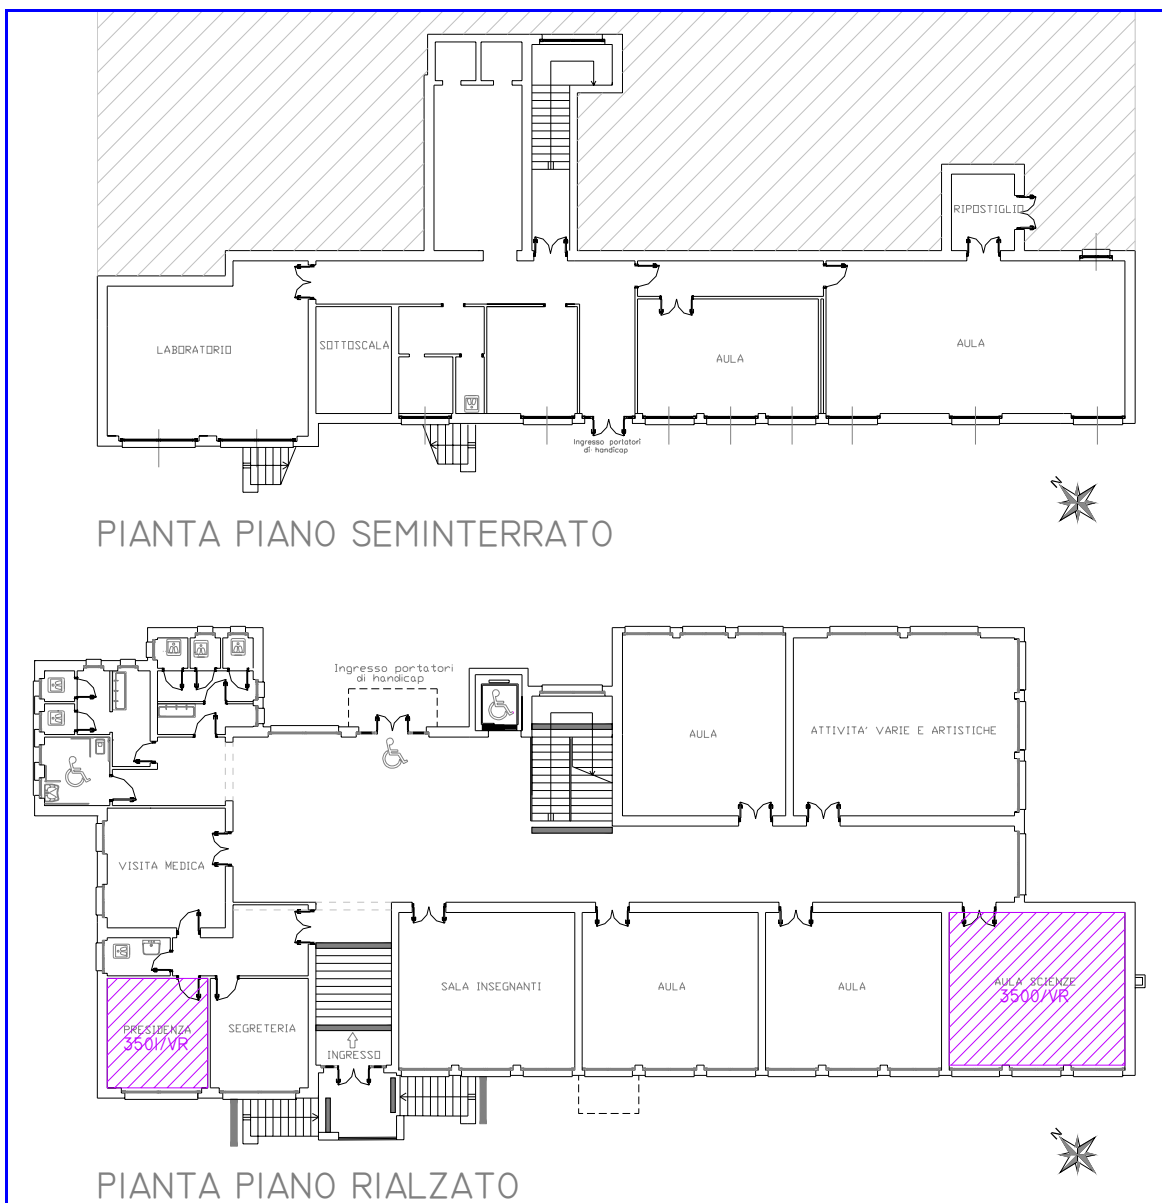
Planimetria piani interrato e rialzato con ubicazione delle prove di carico
